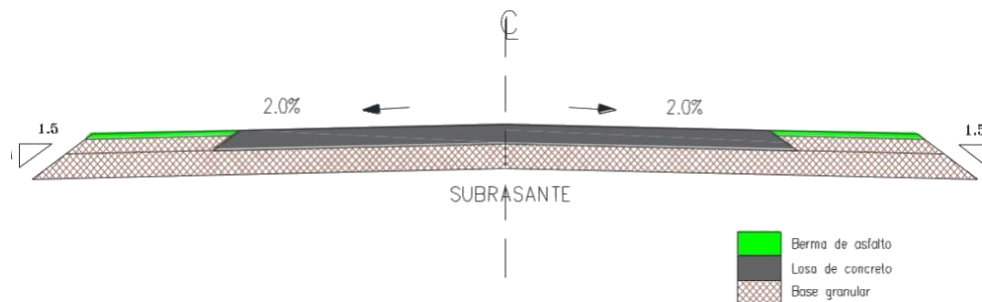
Sección típica pavimento rígido (Fuente: Elaboración propia)
